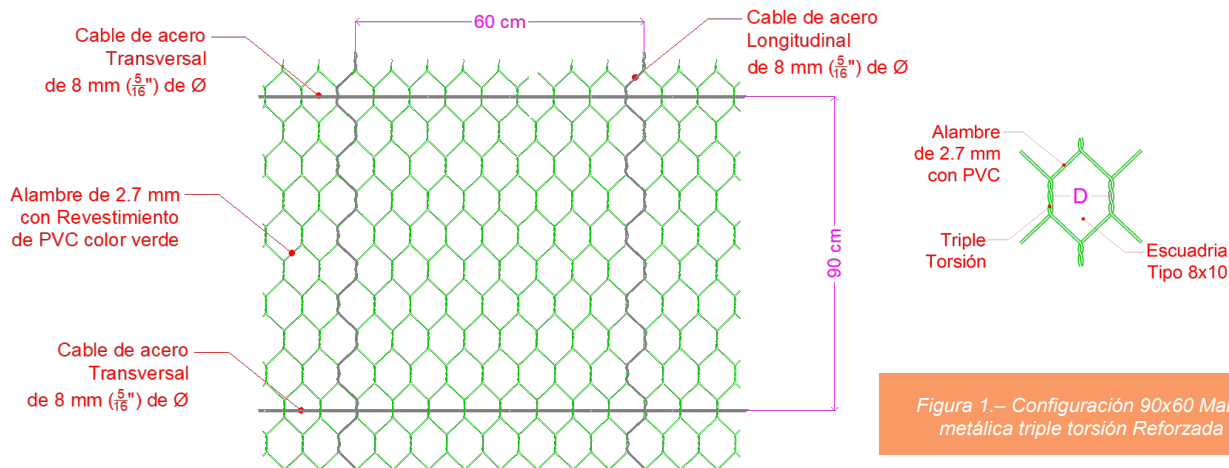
Configuración 90x60 Malla metálica triple torsión Reforzada
